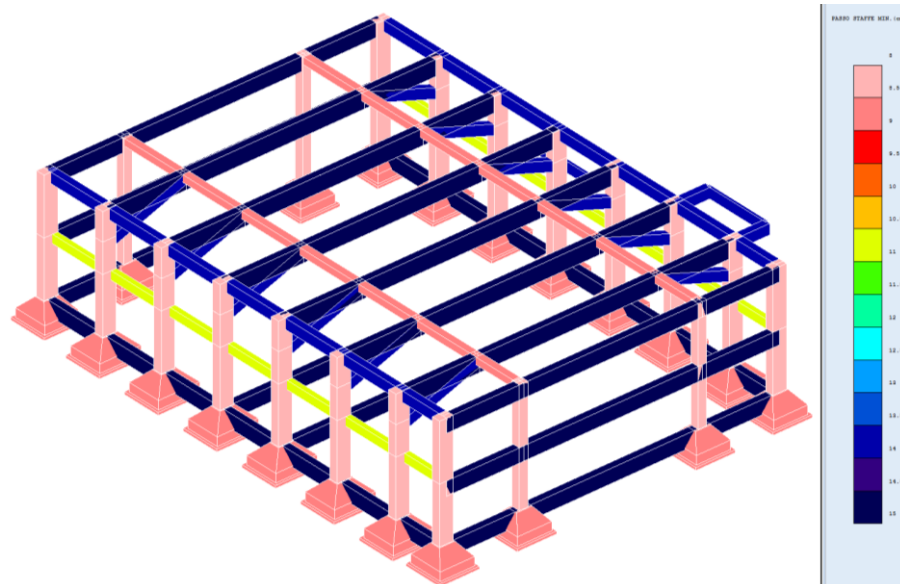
Sipërfaqja e armaturës në prerje për elementët strukturorë
